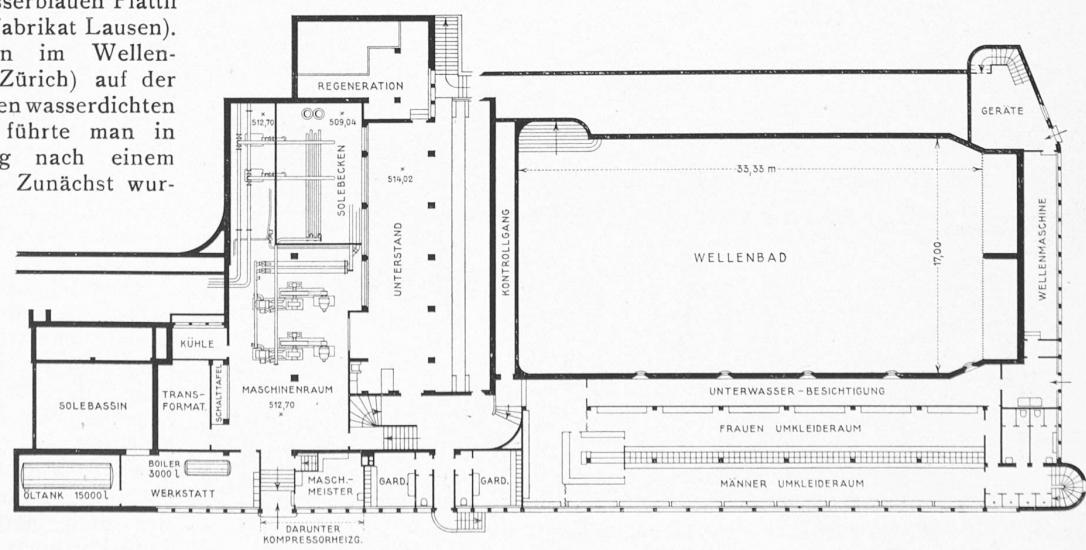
Grundriss vom Untergeschoss des Gebäudes. — Maßstab 1:500.
